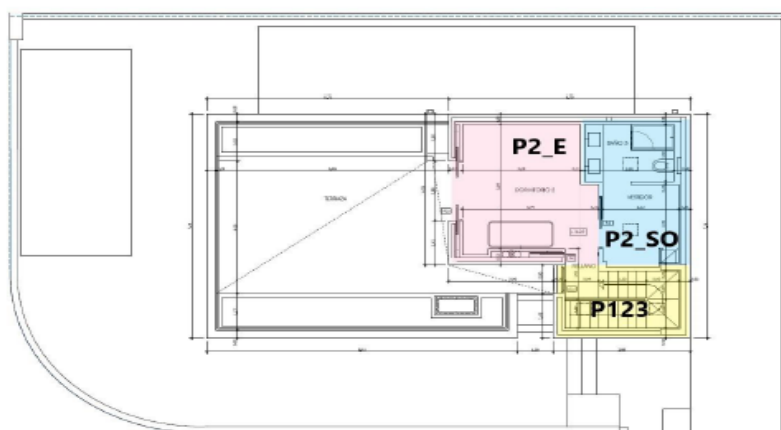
Zonas térmicas de la planta baja. Fuente: [1].
